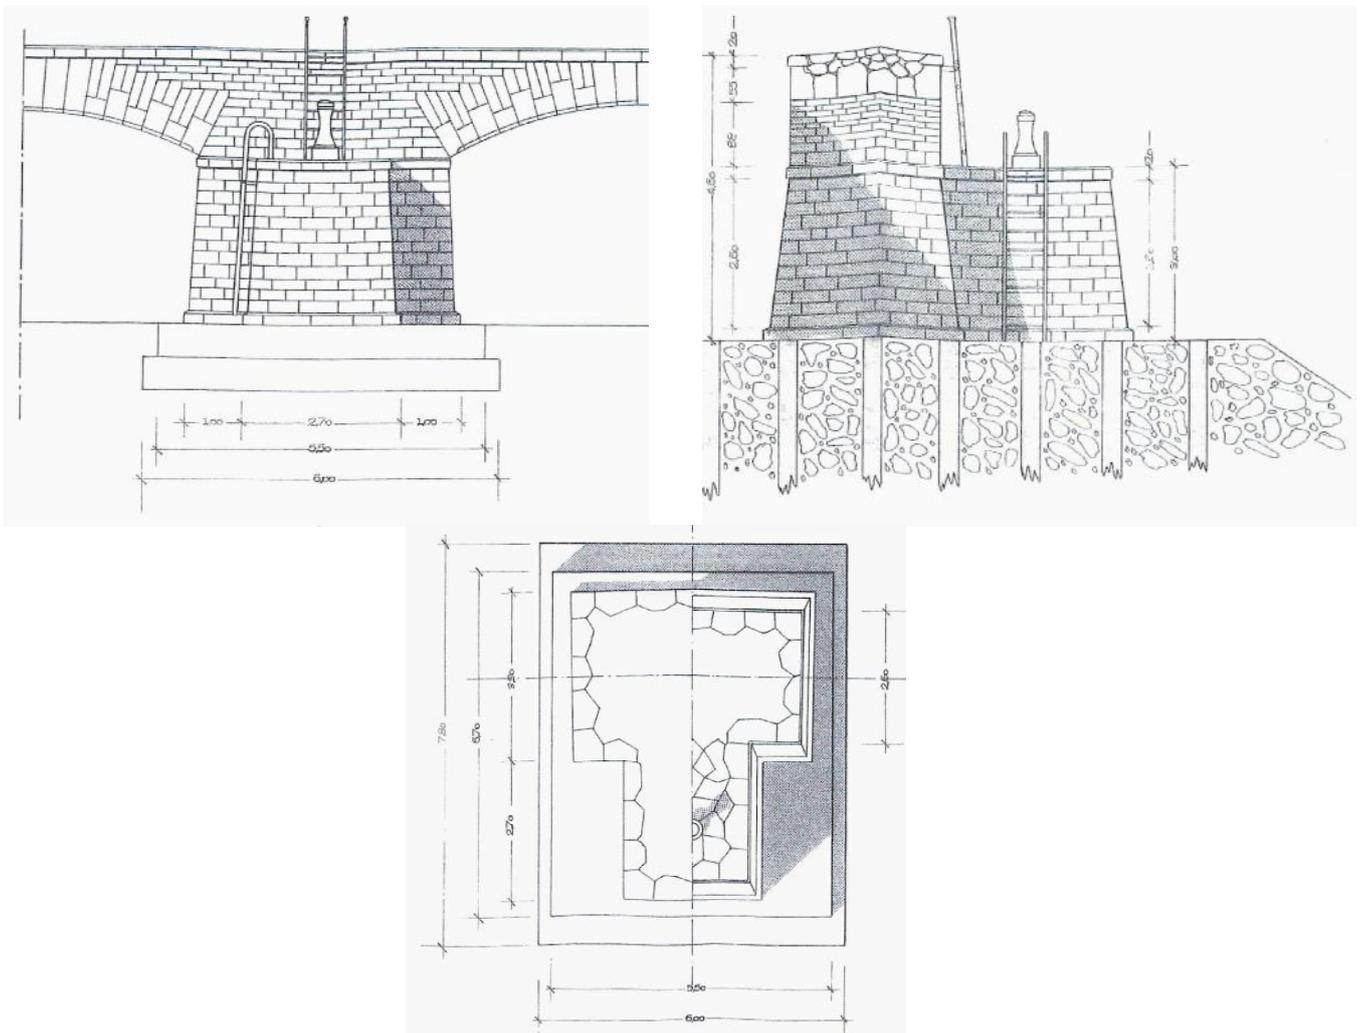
Vue en élévation (en haut à g.) en coupe (en haut à d.) et en plan (en bas) d'une pile culée
